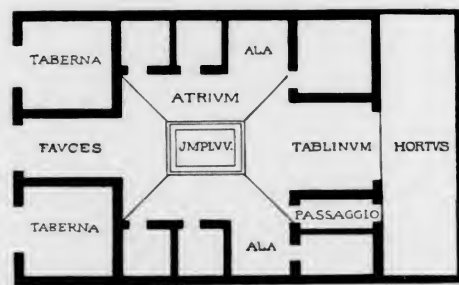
Planta dell'antica casa italica, quale è ricostruita nelle figure 445 e 446.
